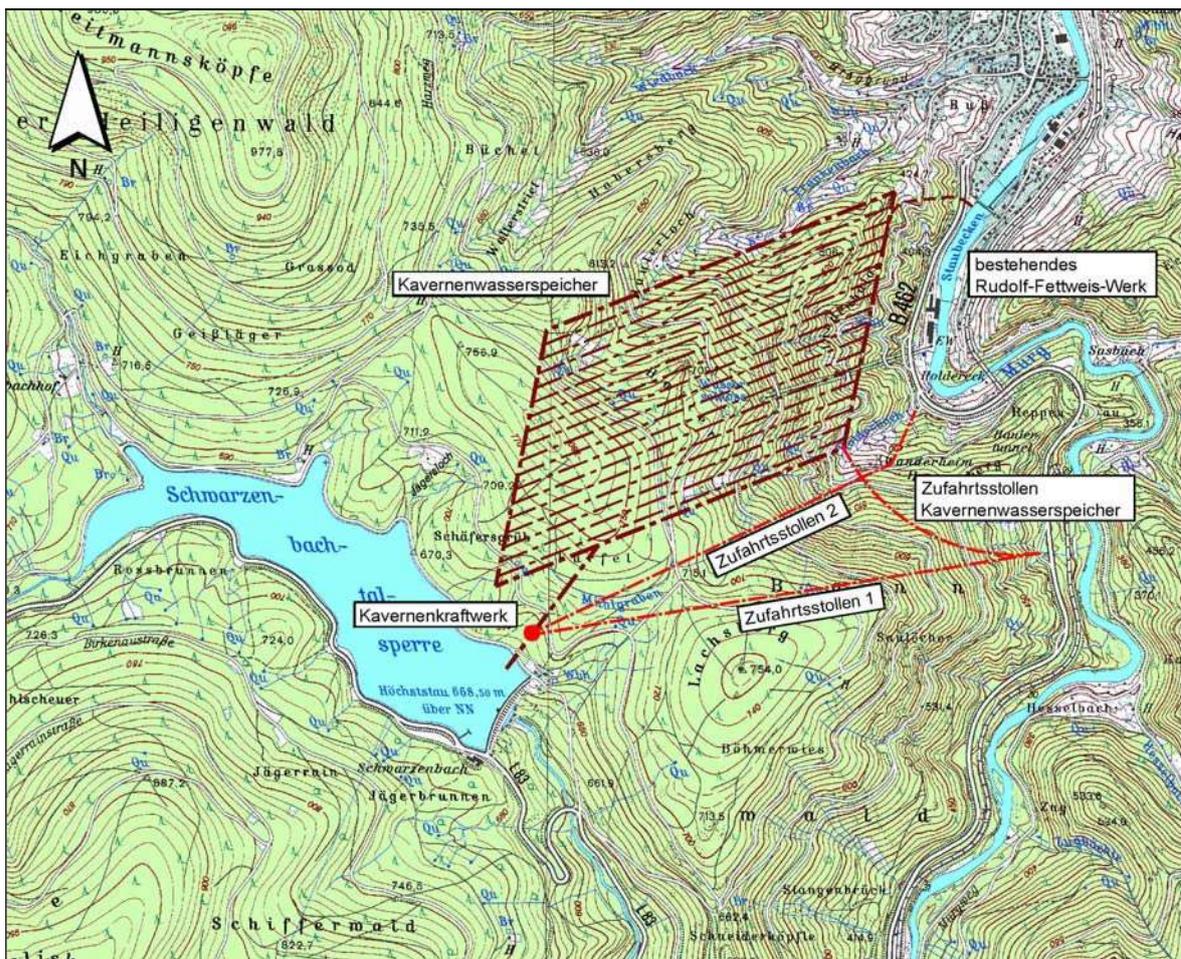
Lageplan Alternative 13 - Unterstufe Kaverne (groß)
